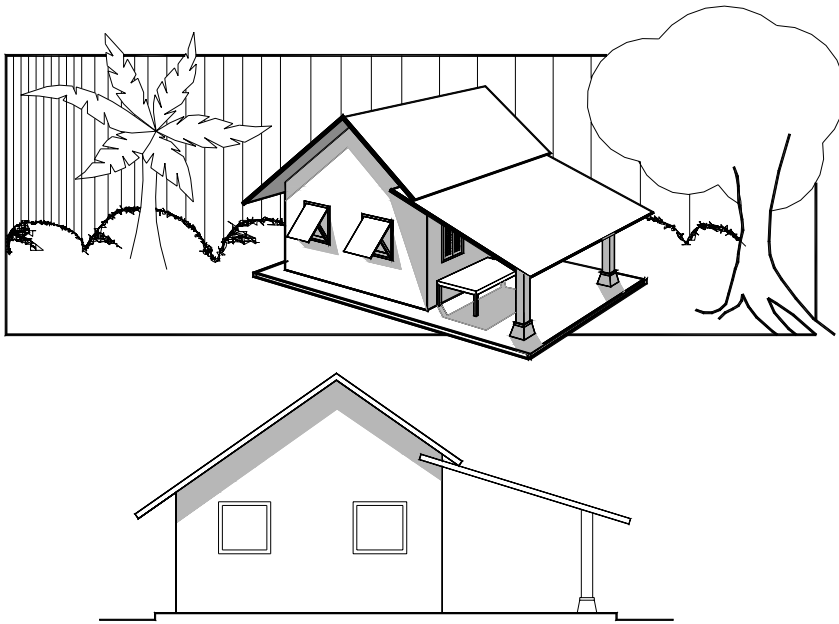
Traditionelles javanisches Haus (Omah Kampung)
